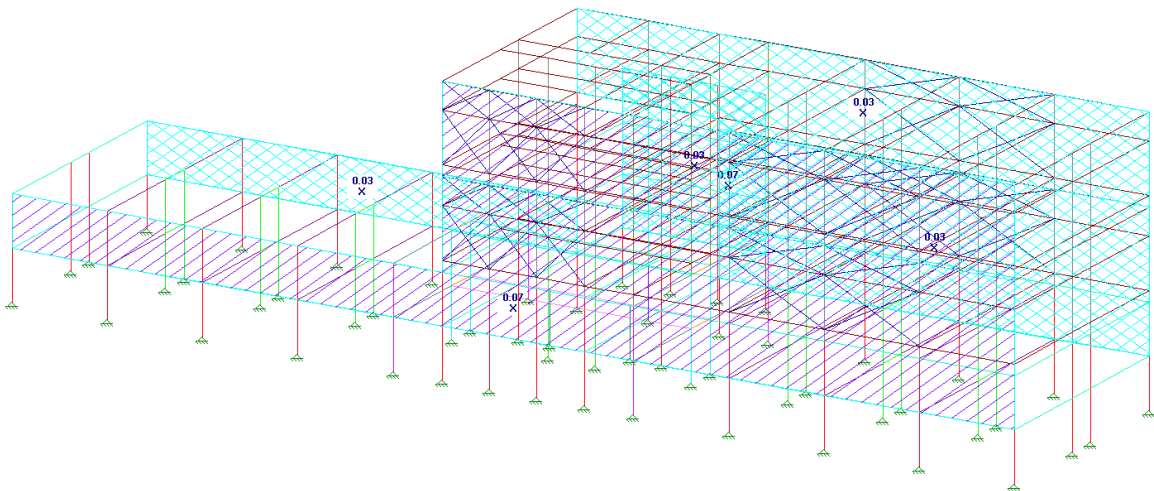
Carregamento do vento em X2 com um pavimento extra
